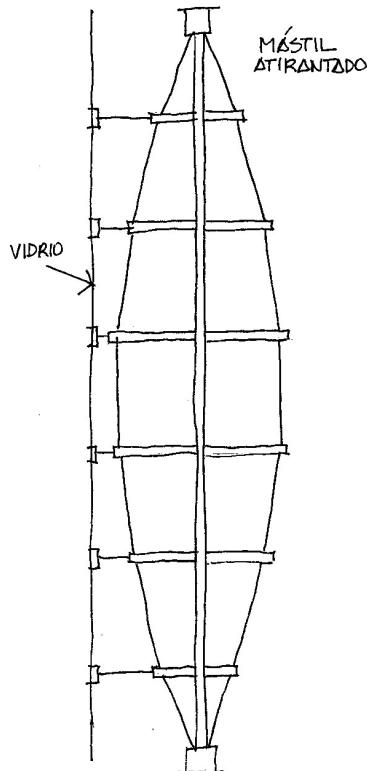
Soporte de fachada mediante mástil atirantado.
